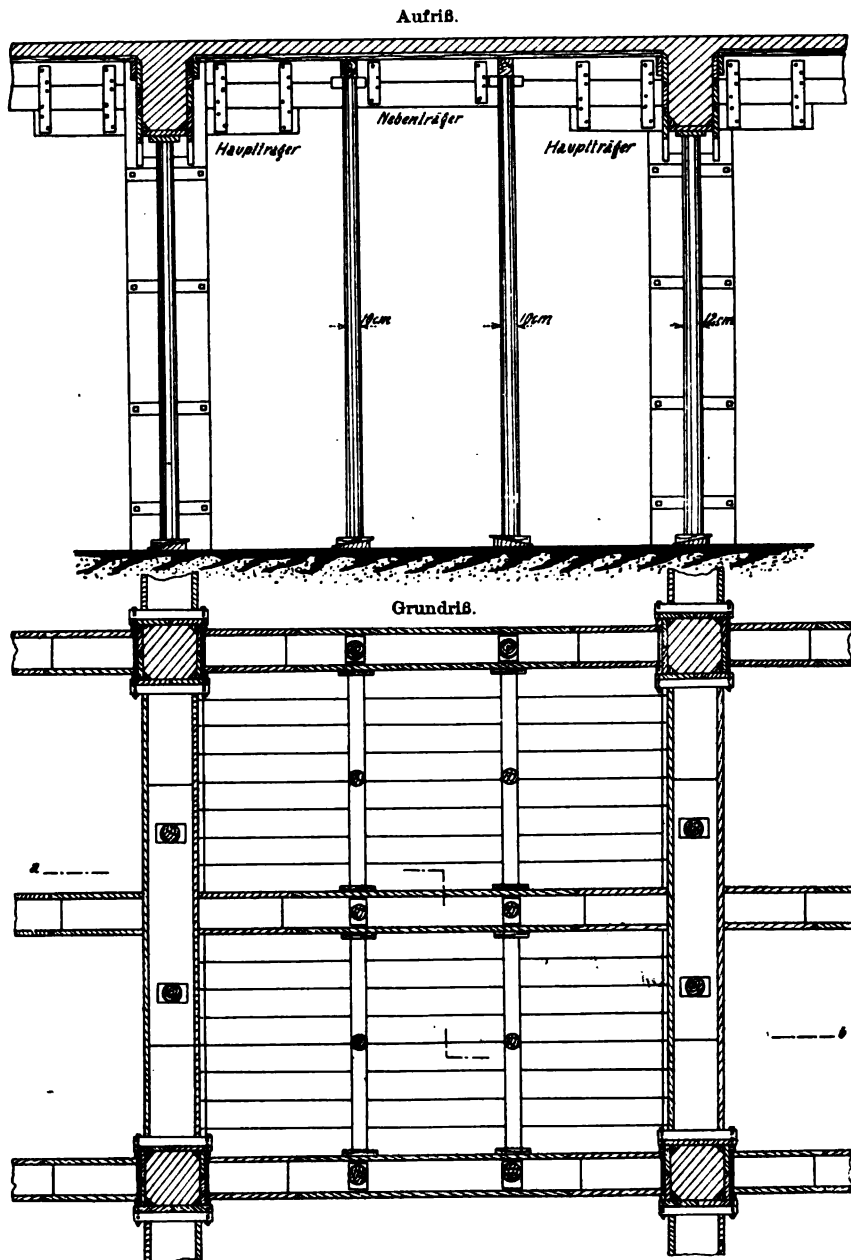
Eingerüstung einer Eisenbetondecke nach Wayss u. Freytag.
